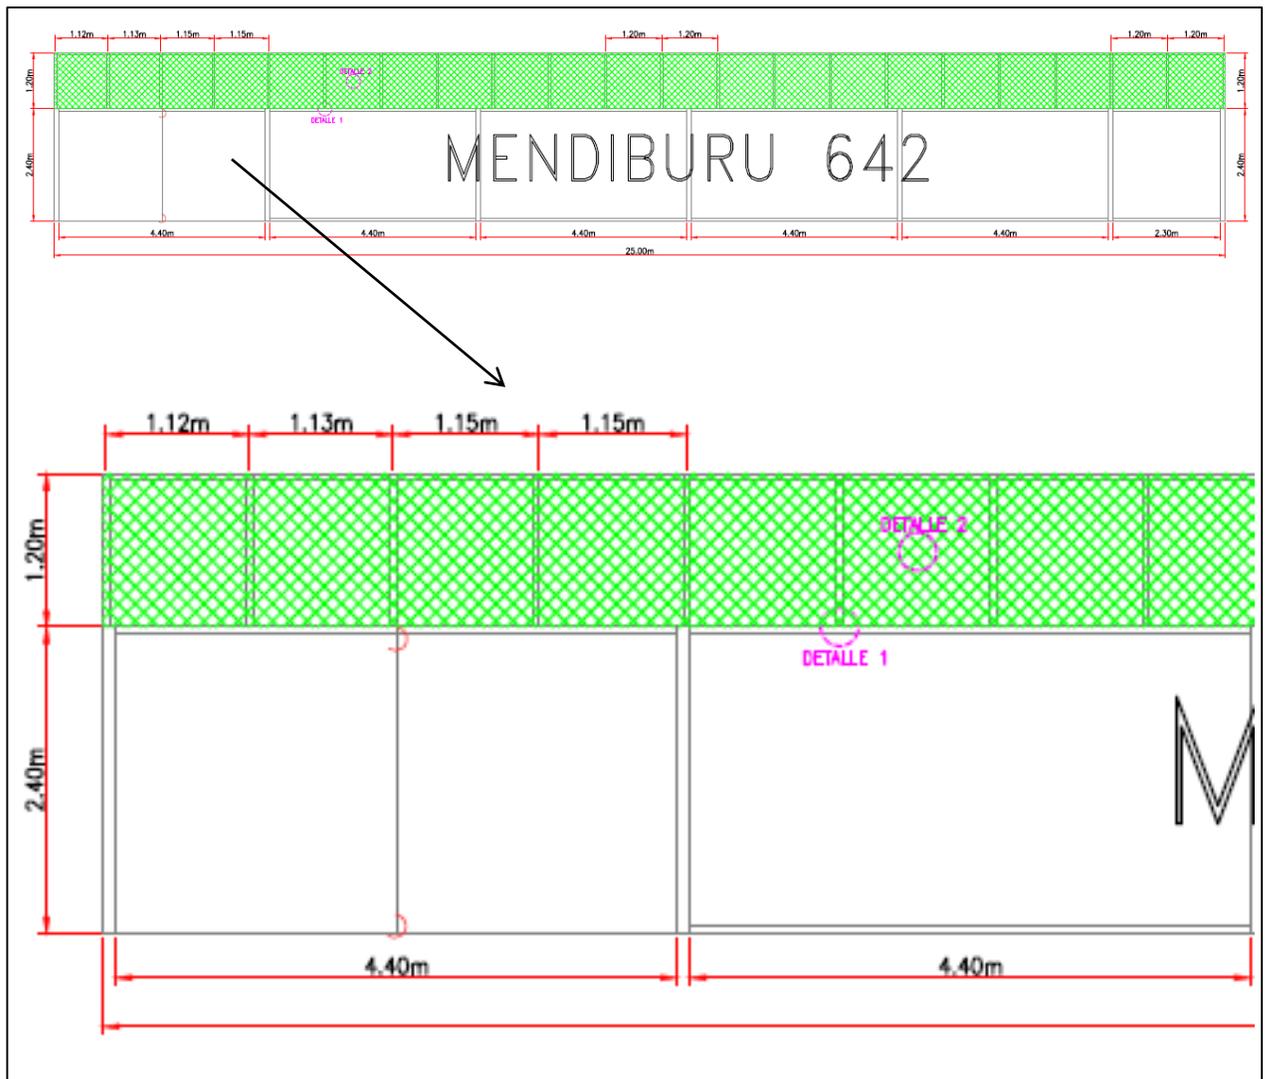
Plano del cerco perimetral frontal de obra, con detalle de paneles a base de malla Raschel.
